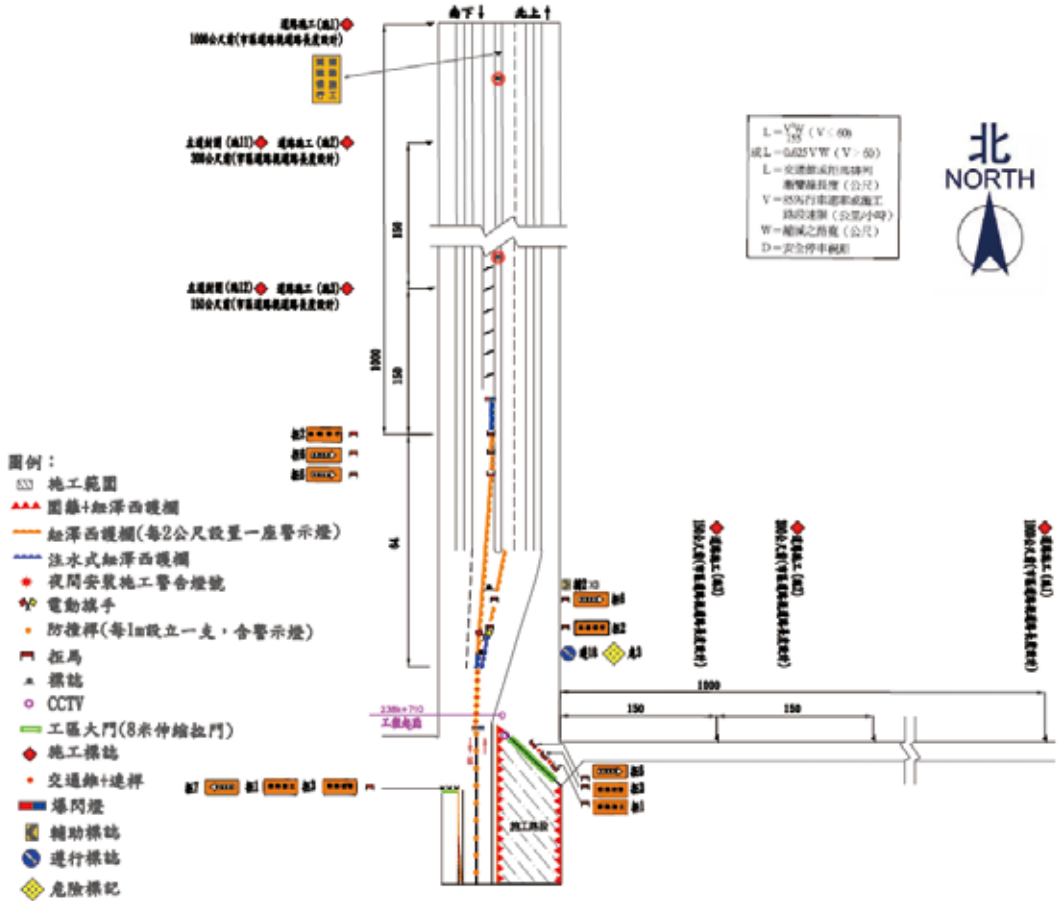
第一階段施工交維車行路徑平面圖示 (北端)
